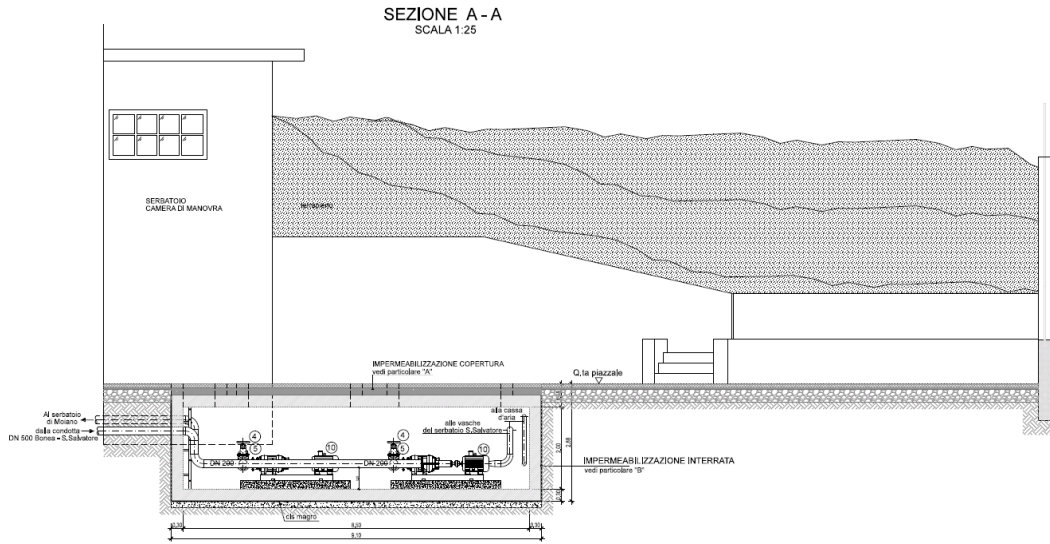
Planimetria dell'intervento previsto in località San Salvatore (impianti di sollevamento interrati al di sotto del piazzale preesistente)
